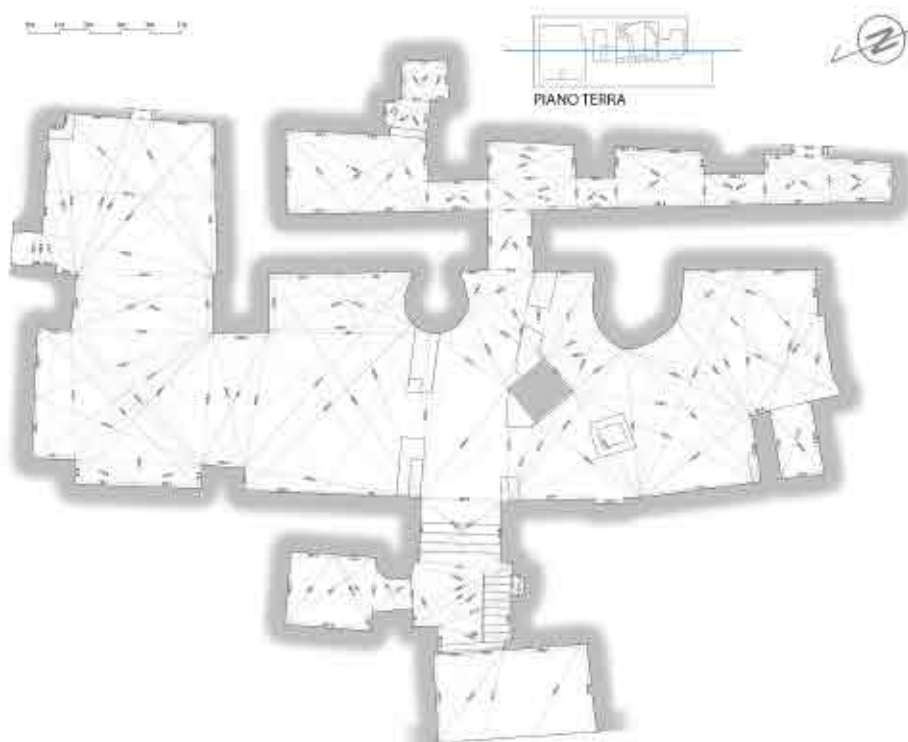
Rilievo: pianta della Chiesa di Sant'Andrea.; Survey: plan of Saint Andrew's church
